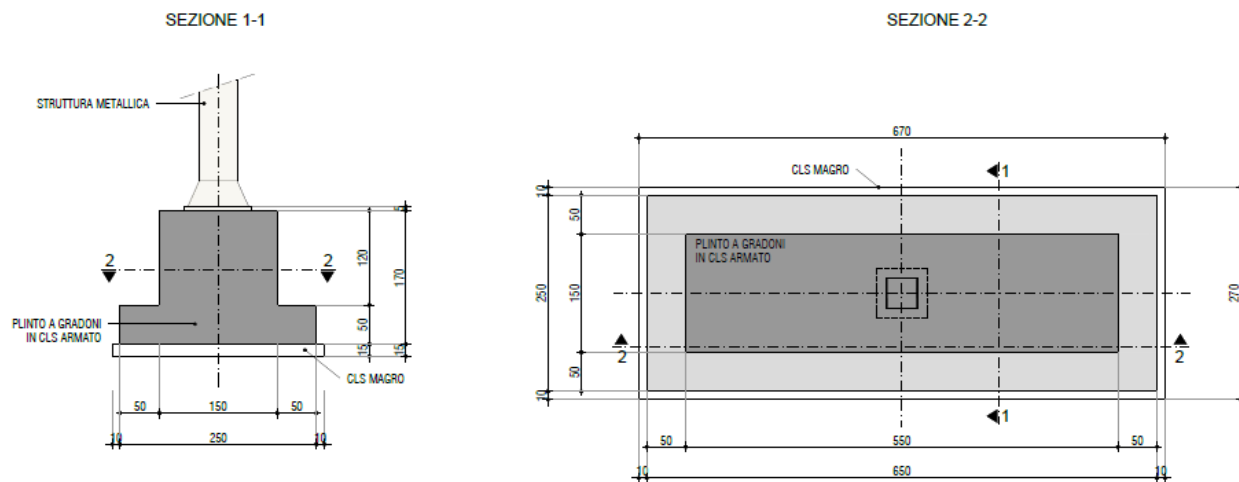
SEGNALE TIPO 4 – PLINTO DI FONDAZIONE
